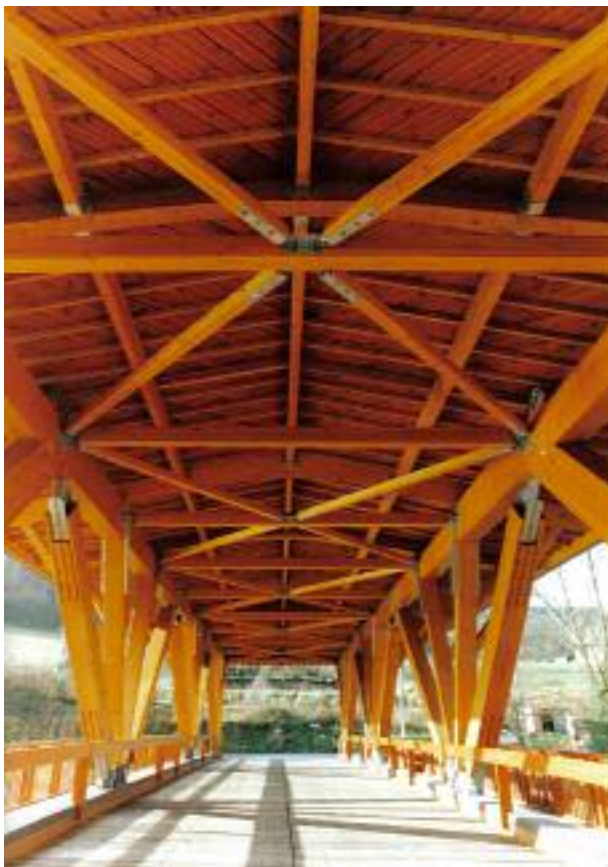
Vue générale du pont sur la Dore, de 33m de portée La structure est un treillis en bois sur laquelle est fixé un platelage en chêne.
